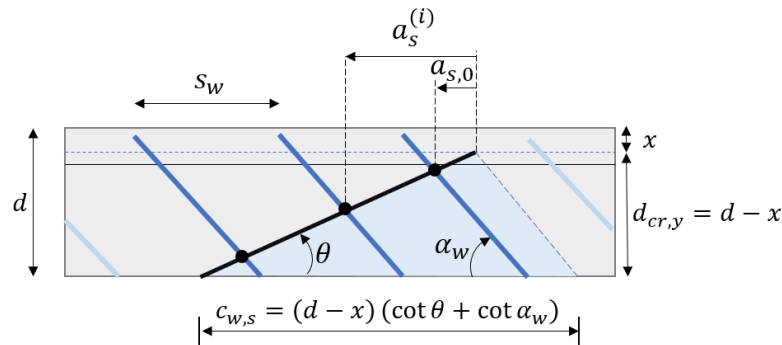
Representação esquemática da posição dos estribos ao longo da fissura crítica.
